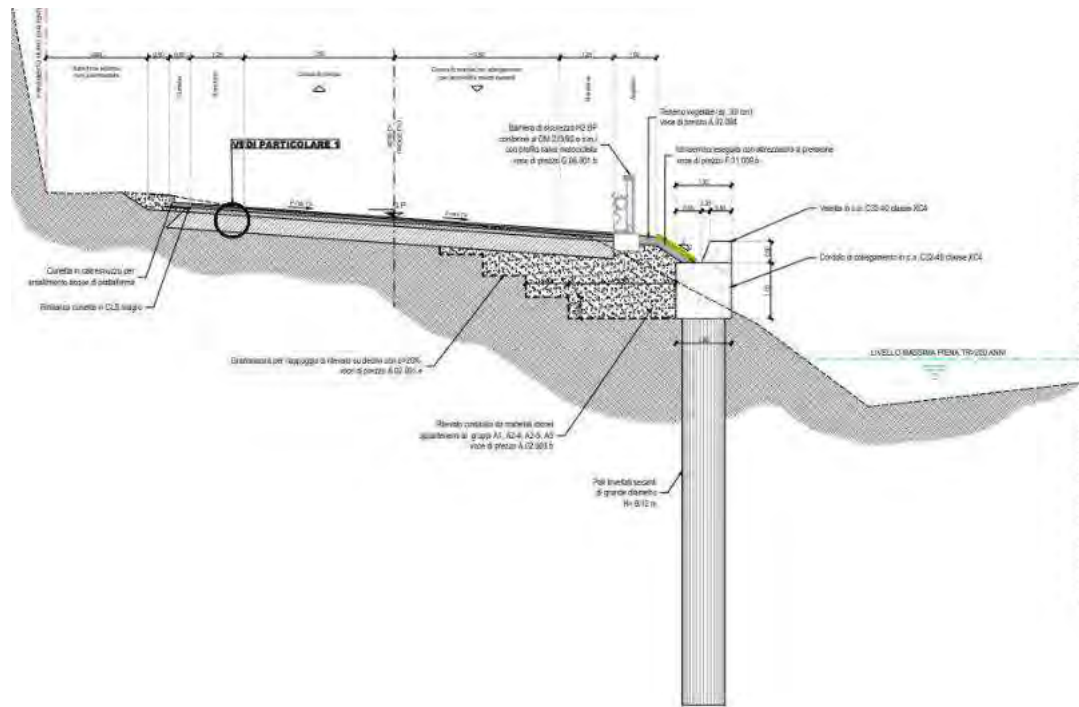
Sezione tipo protezione spondale – C2 in allargamento
